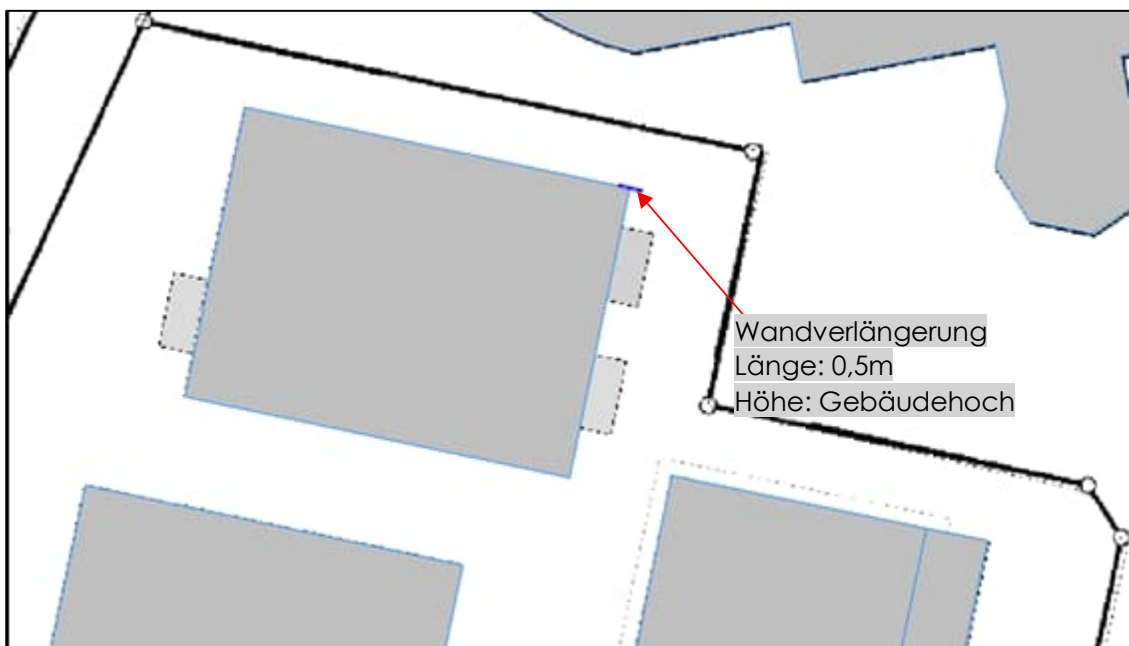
Lageplan mit Kennzeichnung der zusätzlich geplanten Wand
